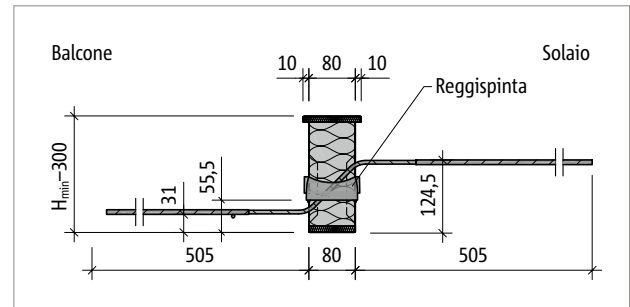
Schöck Isokorb® T tipo QL-V2 – QL-V3: sezione del prodotto
